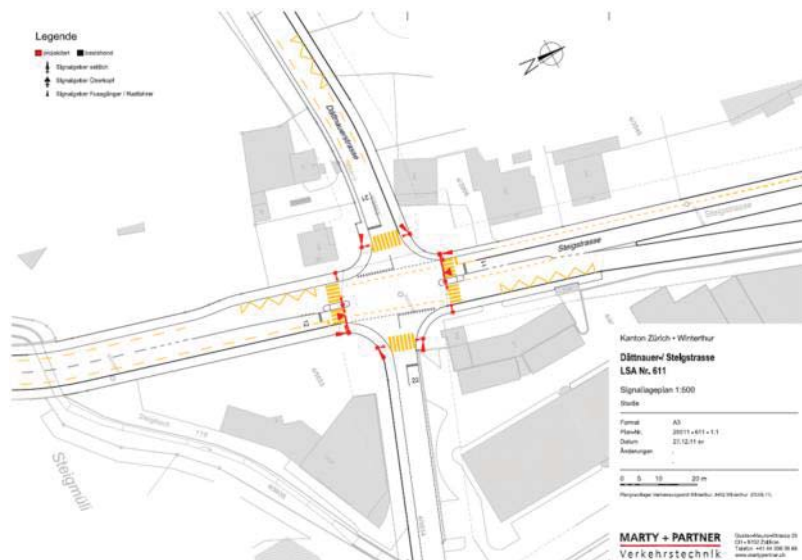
Signallageplan LSA Nr. 611 (vgl. Anhang A6)
